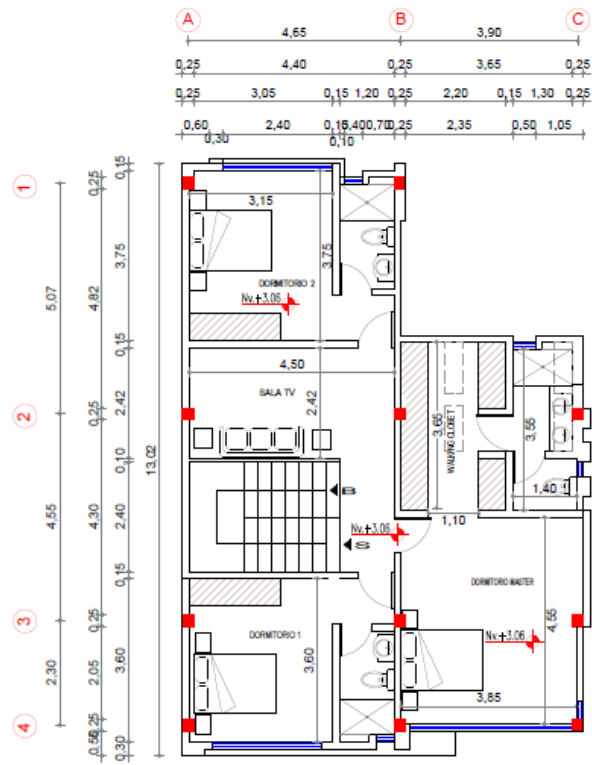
Planta arquitectónica nivel +3.06; +5.94
